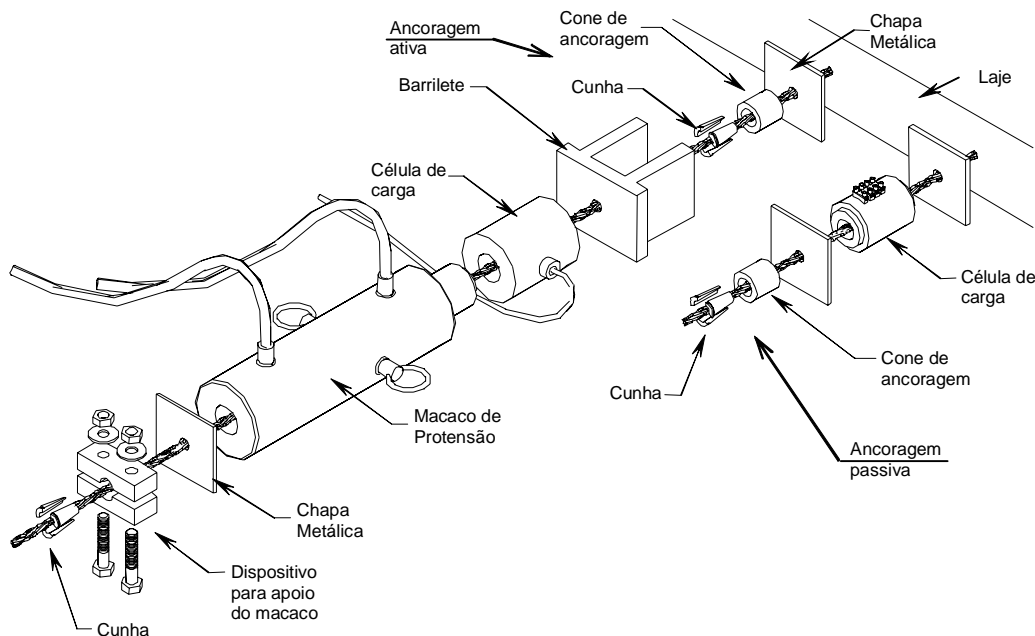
Esquema de protensão – VILLAVERDE (2008).
